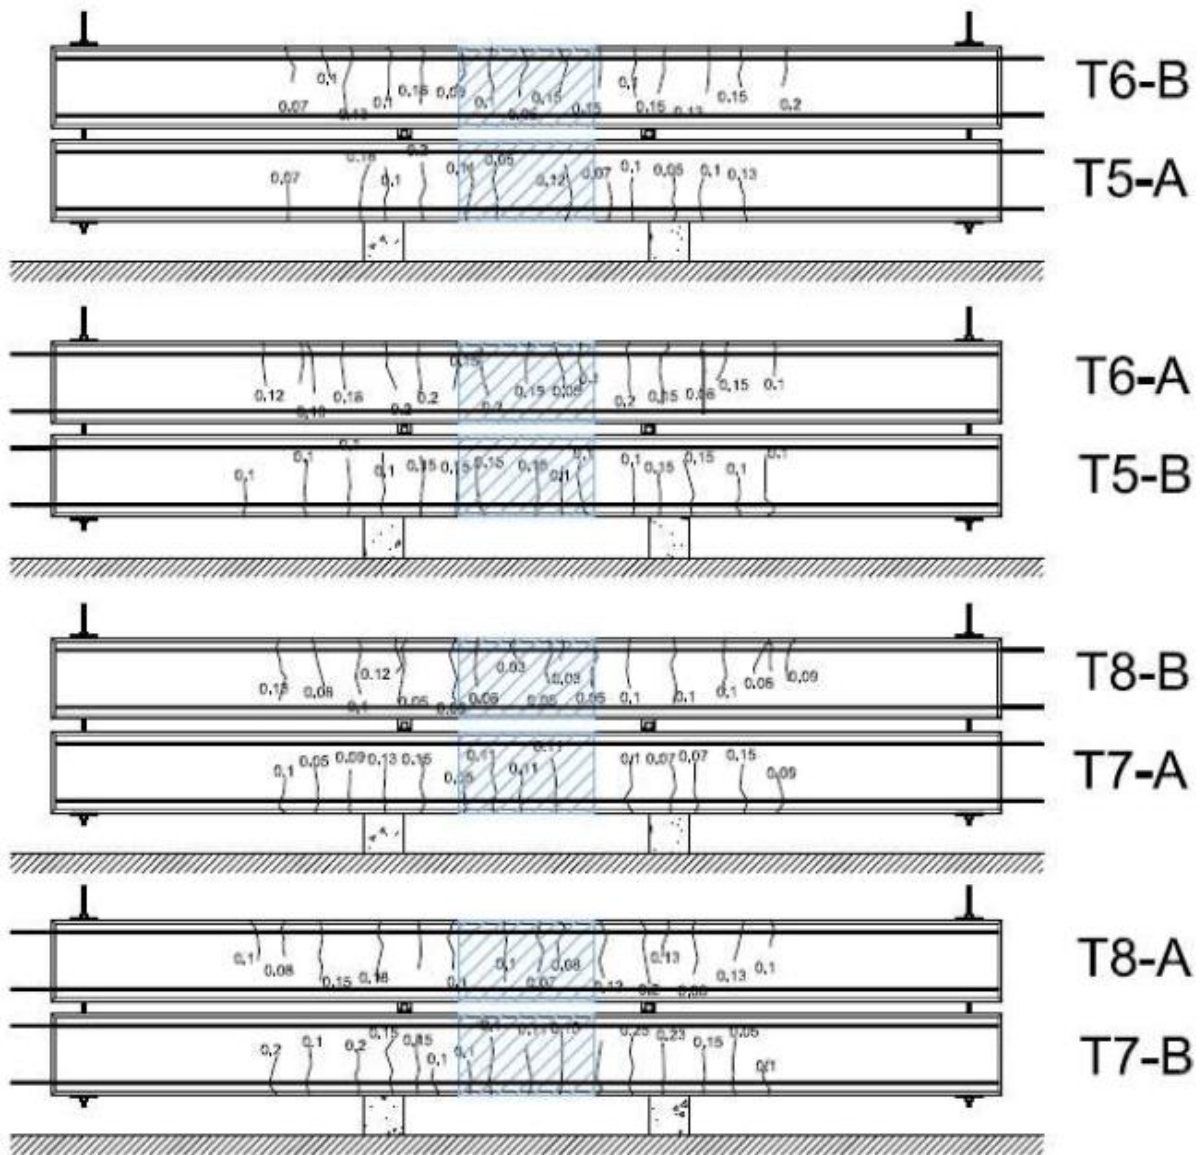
Esquema de grietas de traves T5 a T8 de CR con AR longitudinal a tensión de 10 mm de diámetro.
